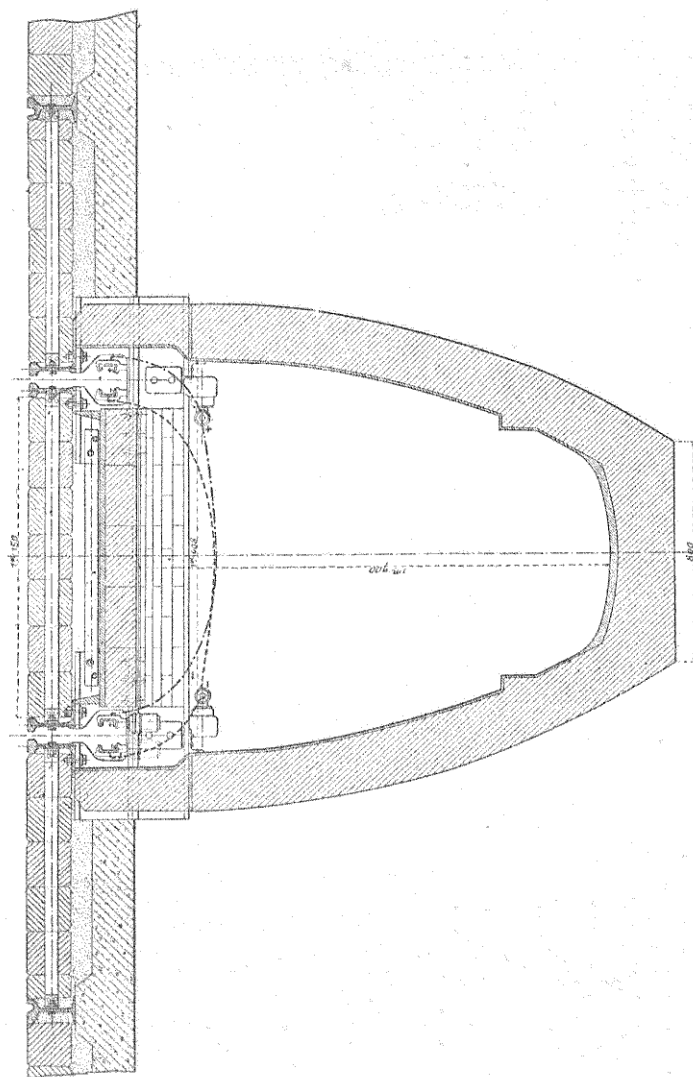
Coupe transversale d'un grand caniveau circulaire.
